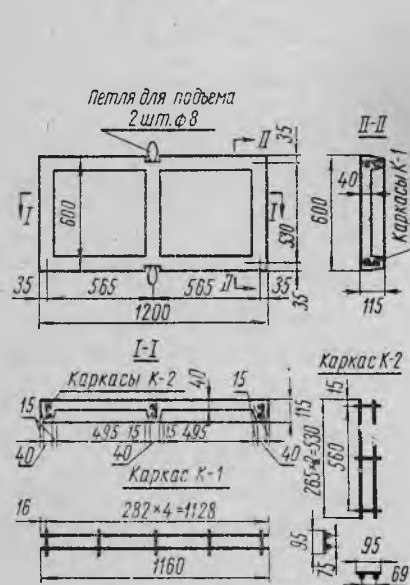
Ребристая железобетонная плита крепления марки П-60×120, марка бетона БГТ-200 (размеры в мм).
